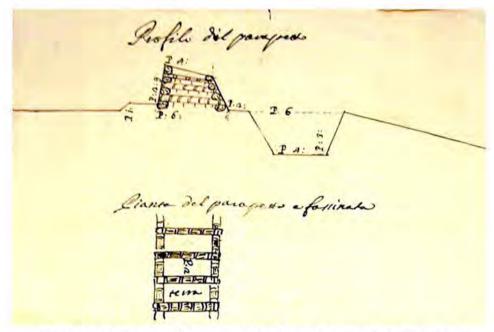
Antonio Bertola, *Il parapeto da farsi sopra le colline* [...], particolare dell'illustrazione con la sezione dell'elevato del trinceramento e della pianta (ASTORiunite, Camerale Piemonte, Articolo 191)
